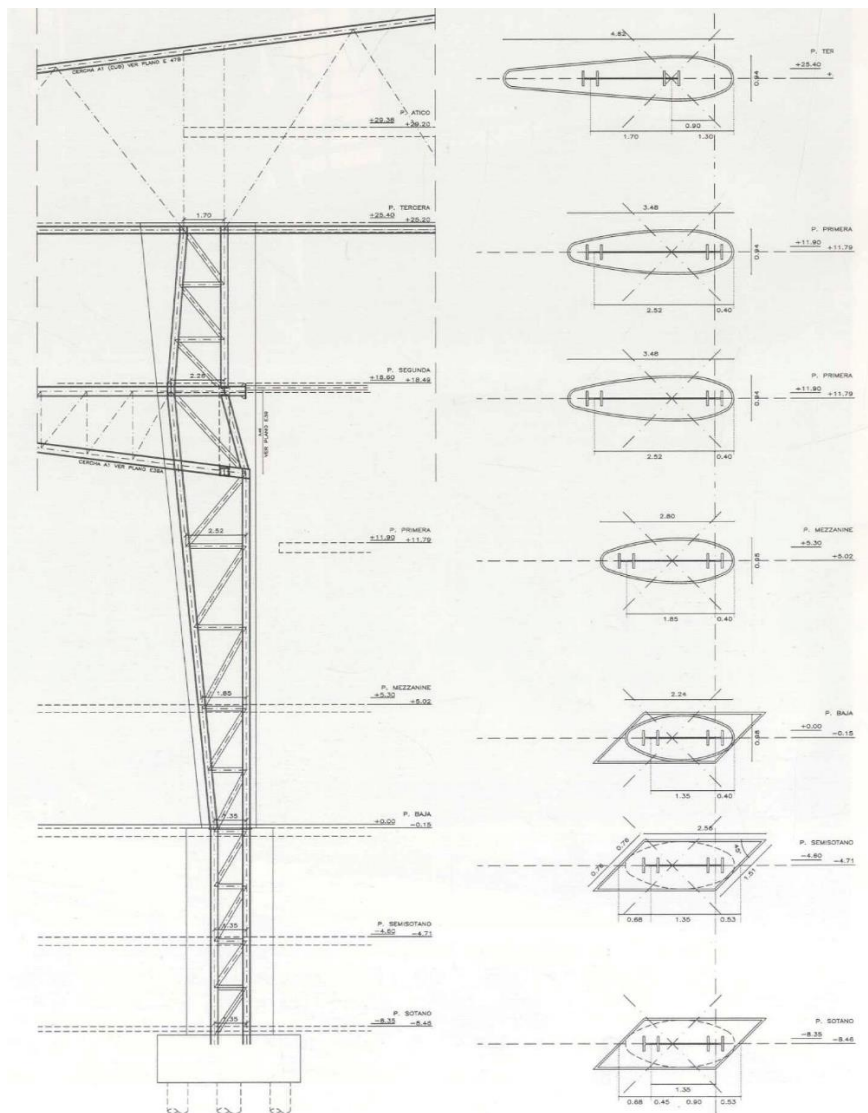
Detalle colocación perfiles interiores del pilar fusiforme.
